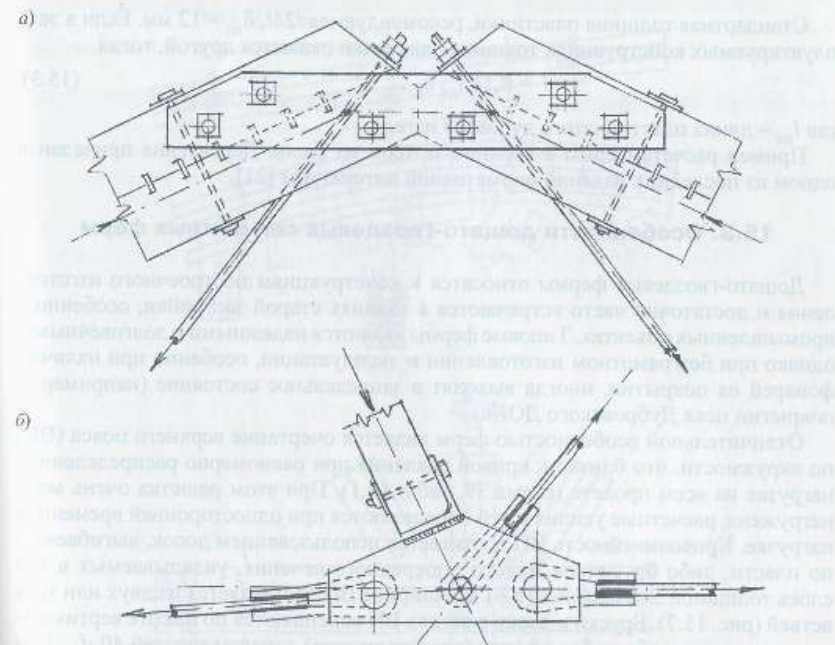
Центровка усилий и узлы треугольной формы с верхним поясом из двух брусьев: а – средний узел верхнего пояса; б – промежуточный узел нижнего пояса
